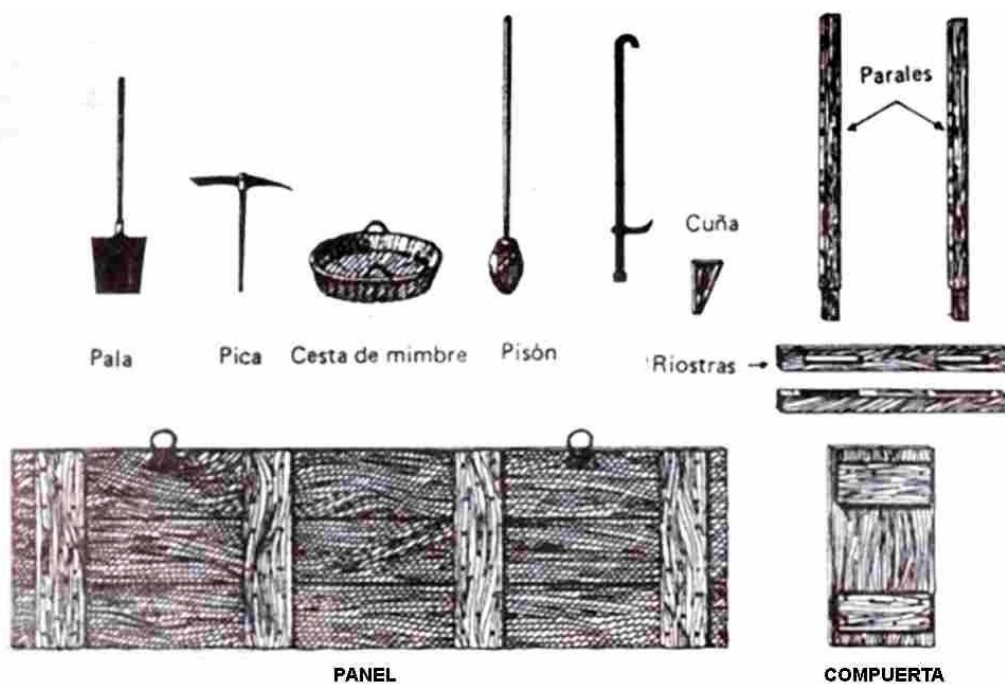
Herramientas necesarias para la construcción de muros en tapia pisada. Fuente: Construcción de muros en tapia y bahareque. SENA.
